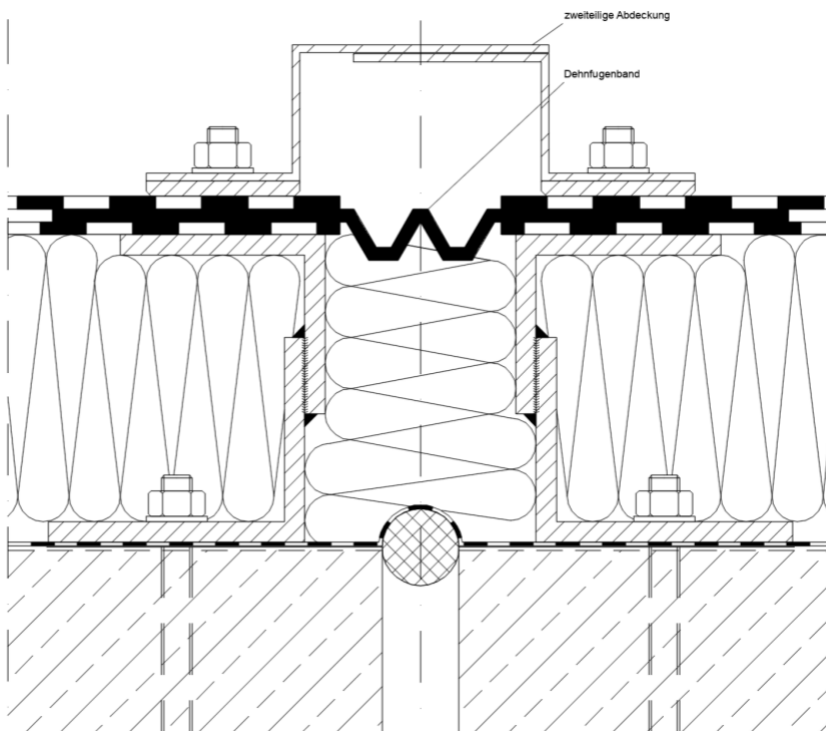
Los- und Festflanschkonstruktionen für wärmedämmte Konstruktionen mit Dehnfugenband und zweiteiliger Abdeckung (z.B. für befahrene Flächen, Begrünungen)
